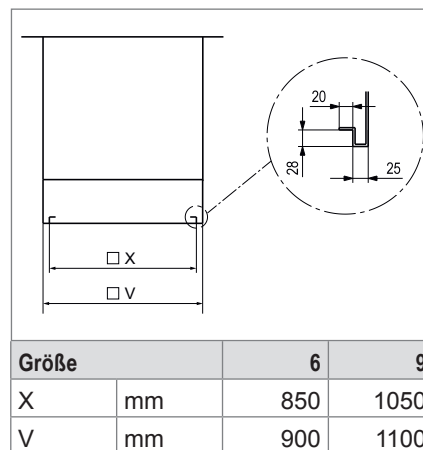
Anschlussmaße für Zuluftkanal (in mm)
